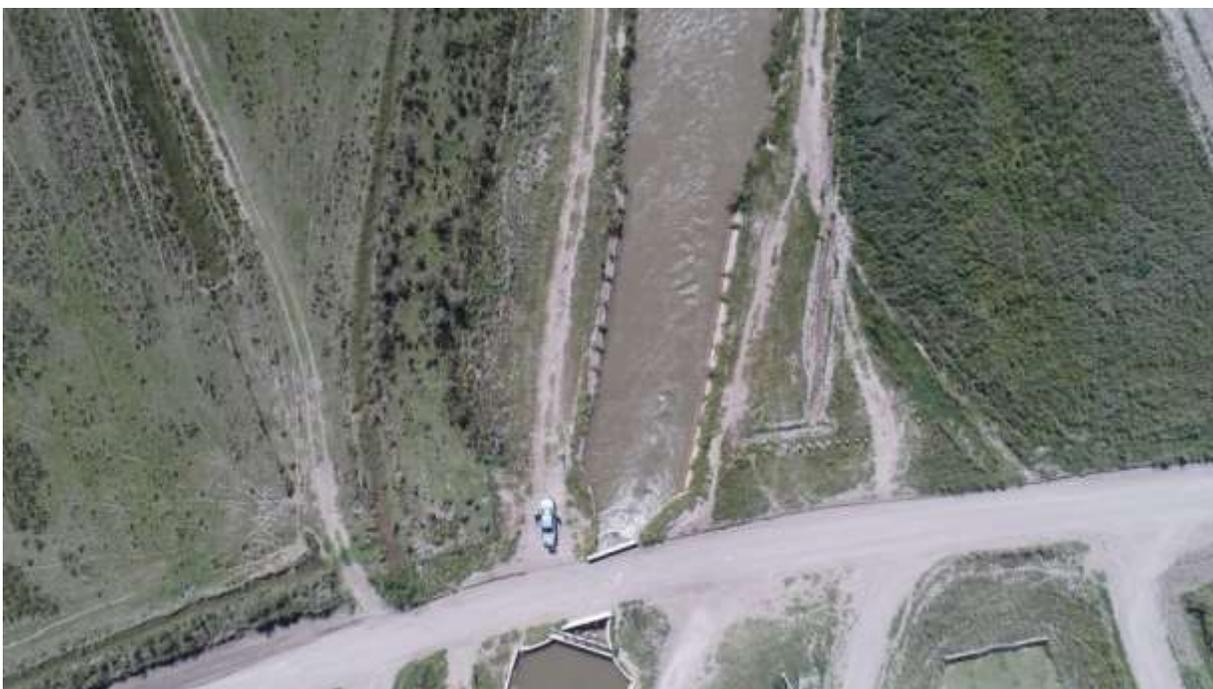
Cruce de Calle 18 sobre Canal Unificador III, zona de obra.
